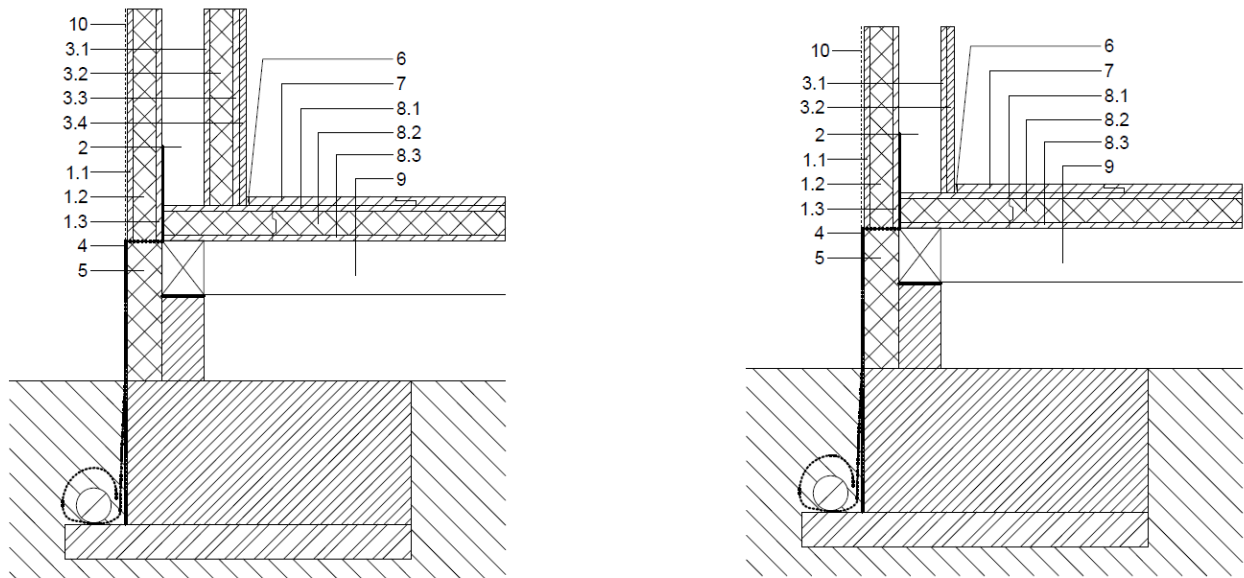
Encuentro tipo de fachada con paneles SATE y WALL con forjado de sanitario. Sección transversal vertical.
